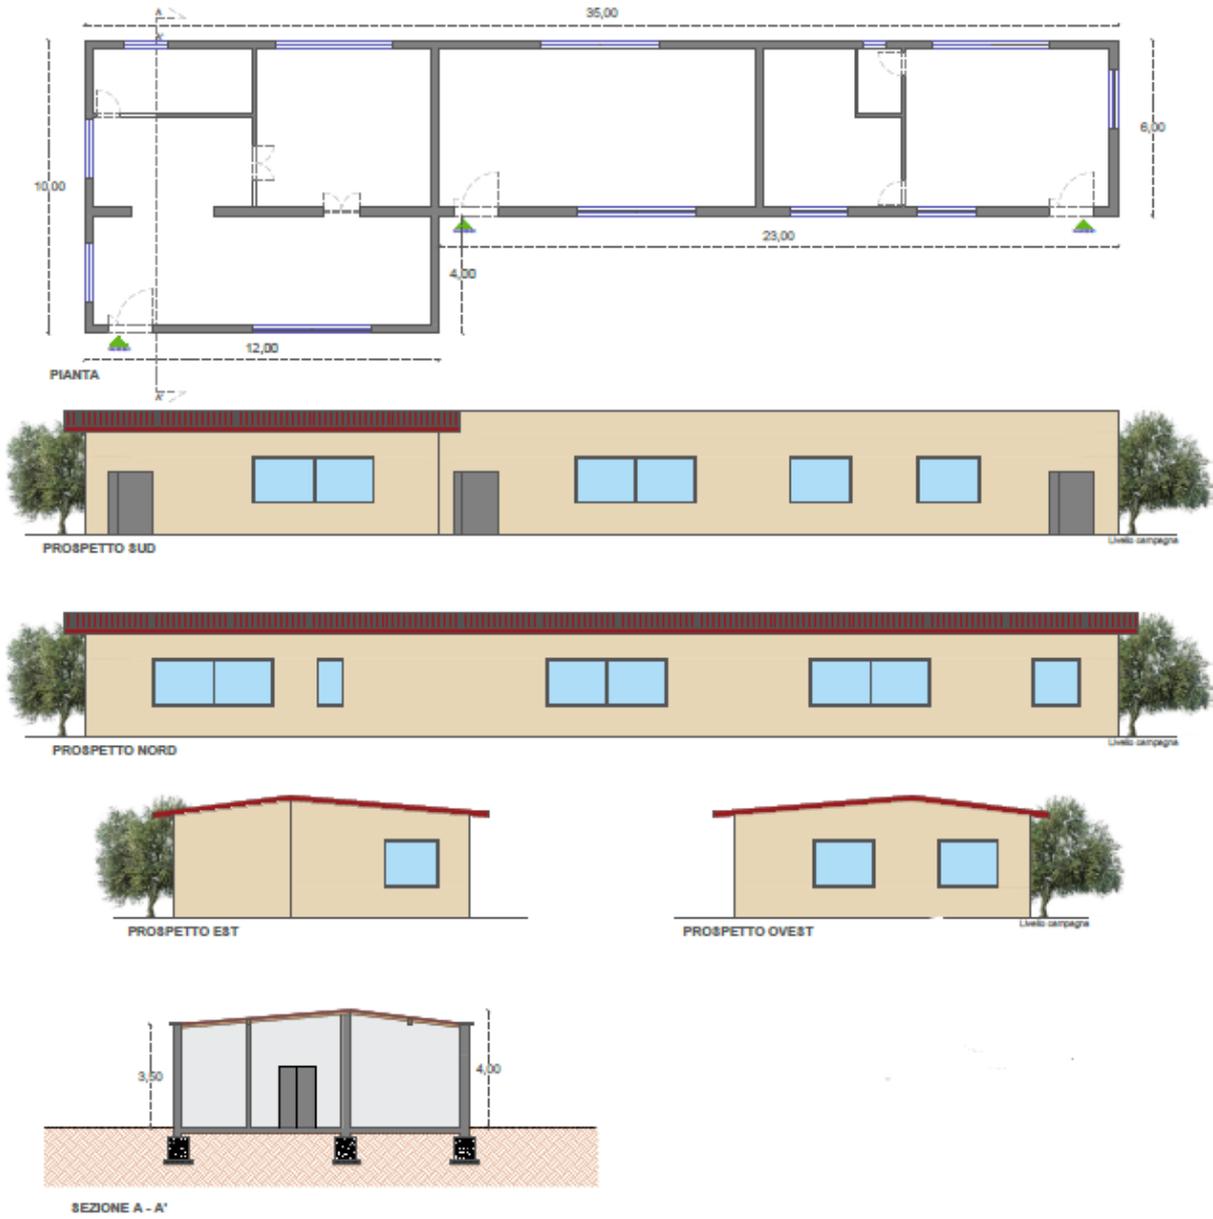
Pianta, Prospetti e Sezione del fabbricato rurale agricolo n°1
